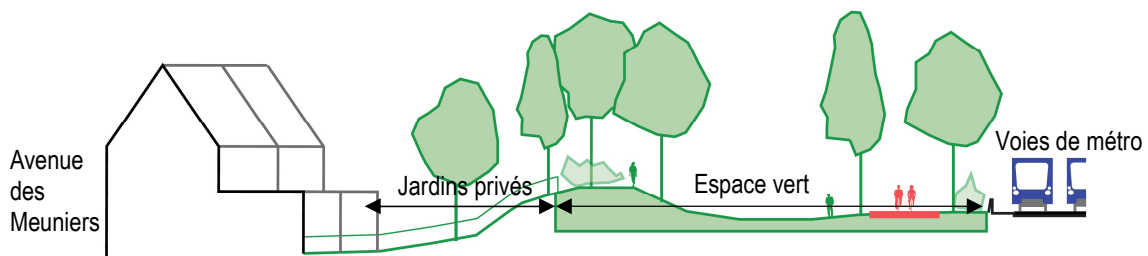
Coupe dans le parc (ARIES sur fond ORG², 2018)
